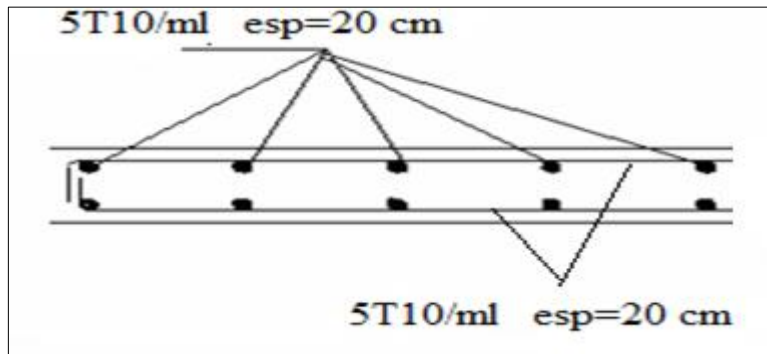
Disposition constructive des armatures de la dalle pleine
